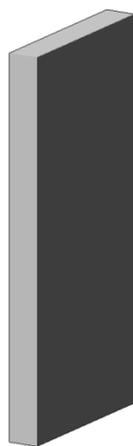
Монолитная железобетонная колонна-пилон
